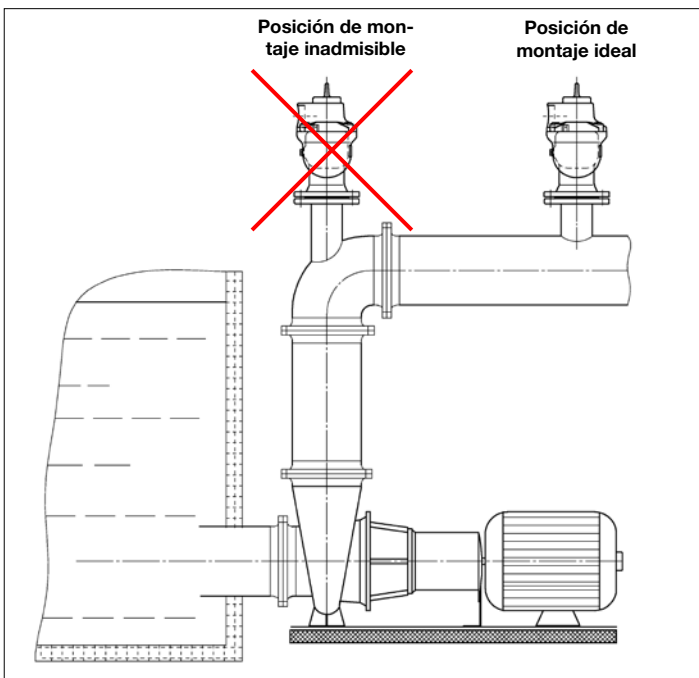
Posición de montaje detrás de instalaciones de bombeo
